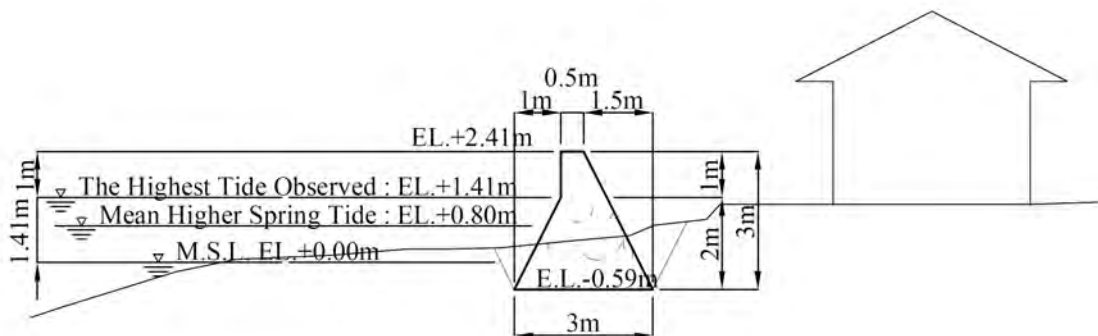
海岸堤 Type B (パラペット壁) 標準断面図
